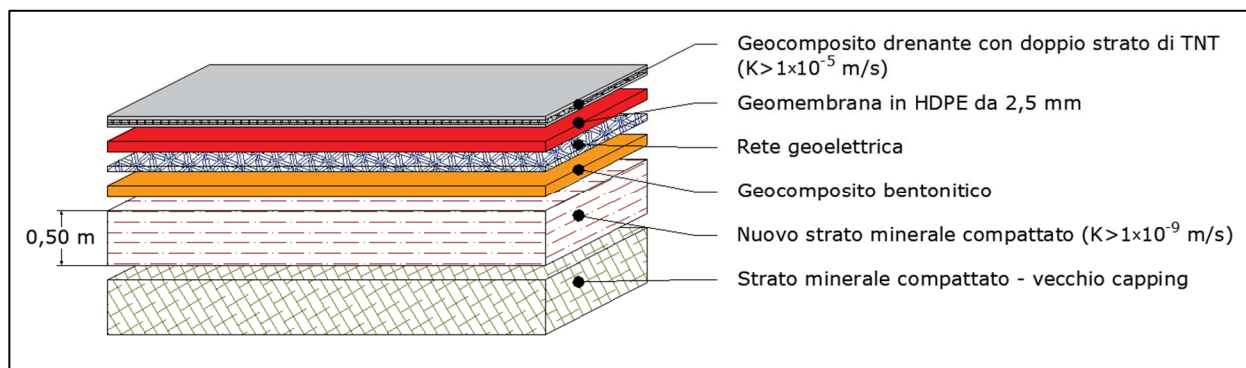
/XIX: Pacchetto impermeabilizzazione
